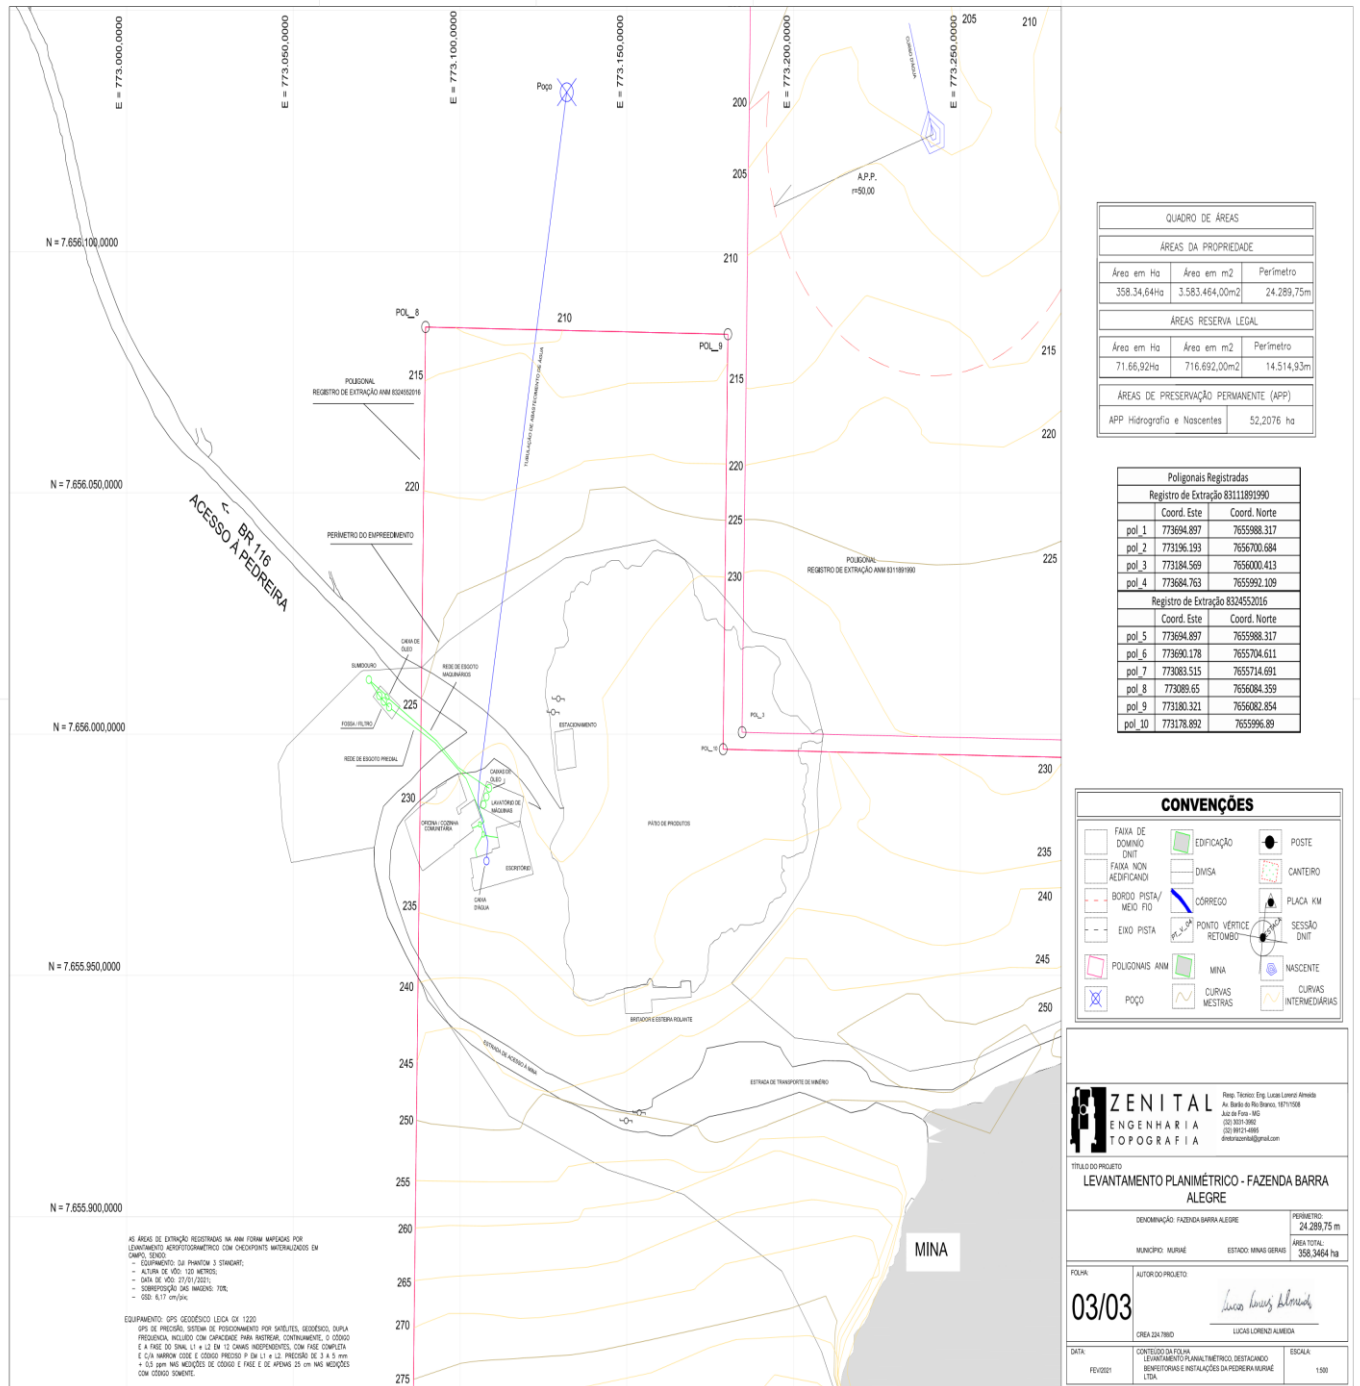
imagem mais detalhada da planta planimétrica georreferenciada do empreendimento
